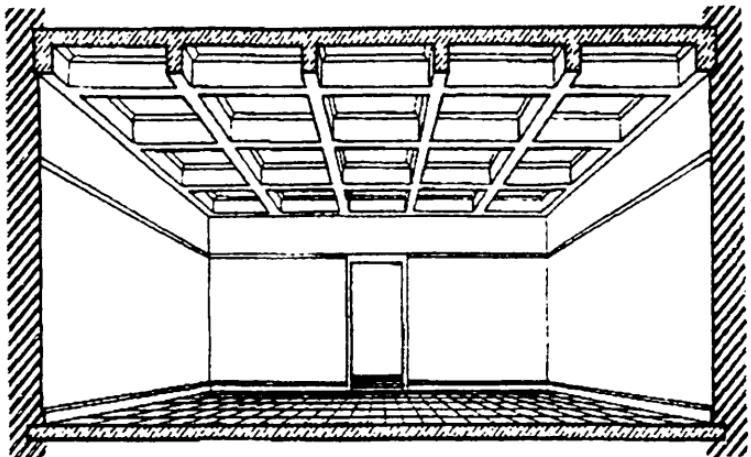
Общий вид железобетонного монолитного кессонного перекрытия
